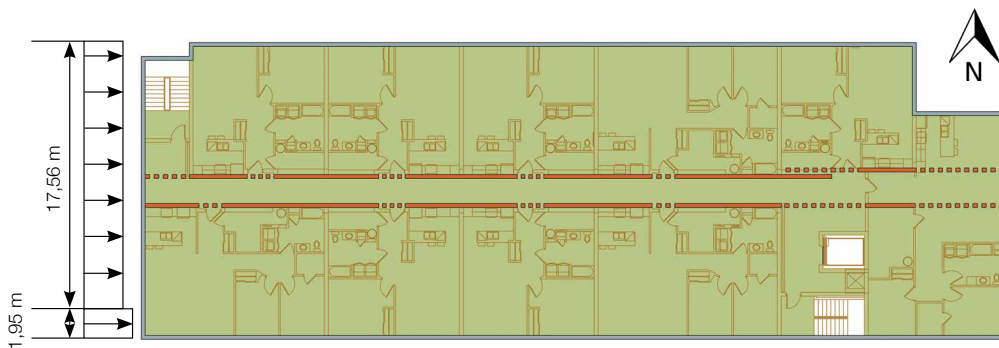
• Vue en plan – Charges de vent direction est-ouest
